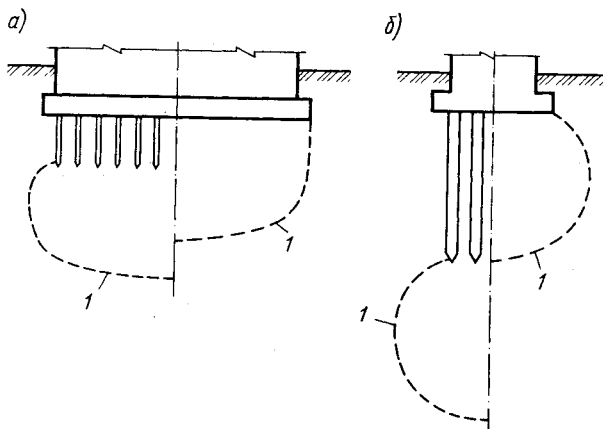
Схема передачи нагрузки на грунт в основании свайного и обычного фундаментов:
